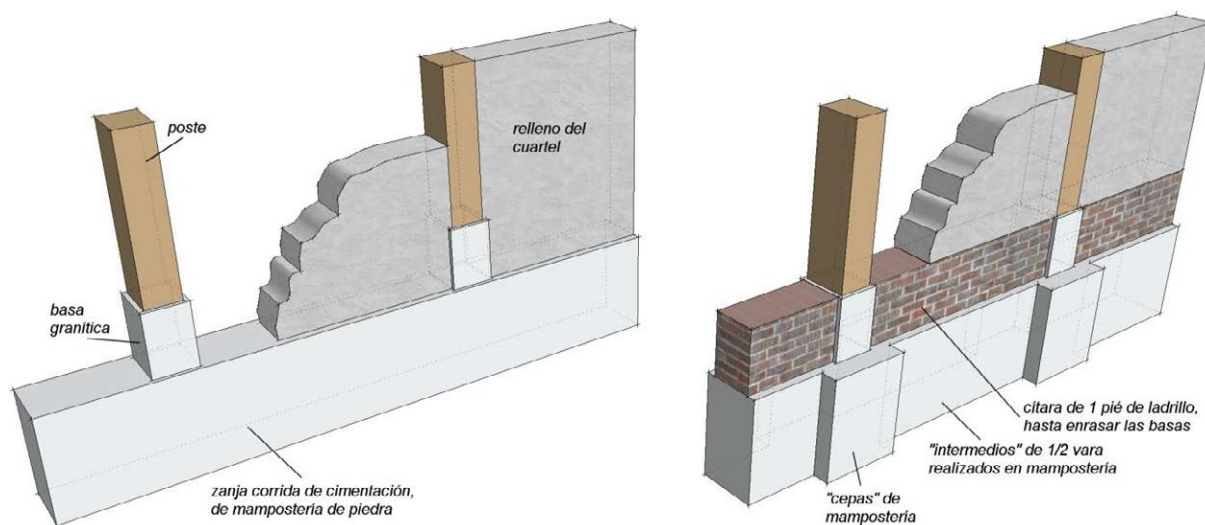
Cimentación de muro entramado mediante zanja corrida y mediante “cepas” y murete de fábrica
